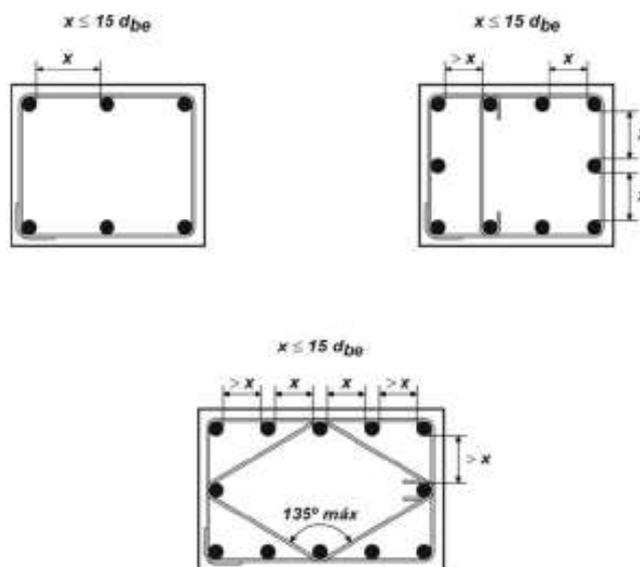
Distintos esquemas de distribución transversal de las barras longitudinales en columnas.
